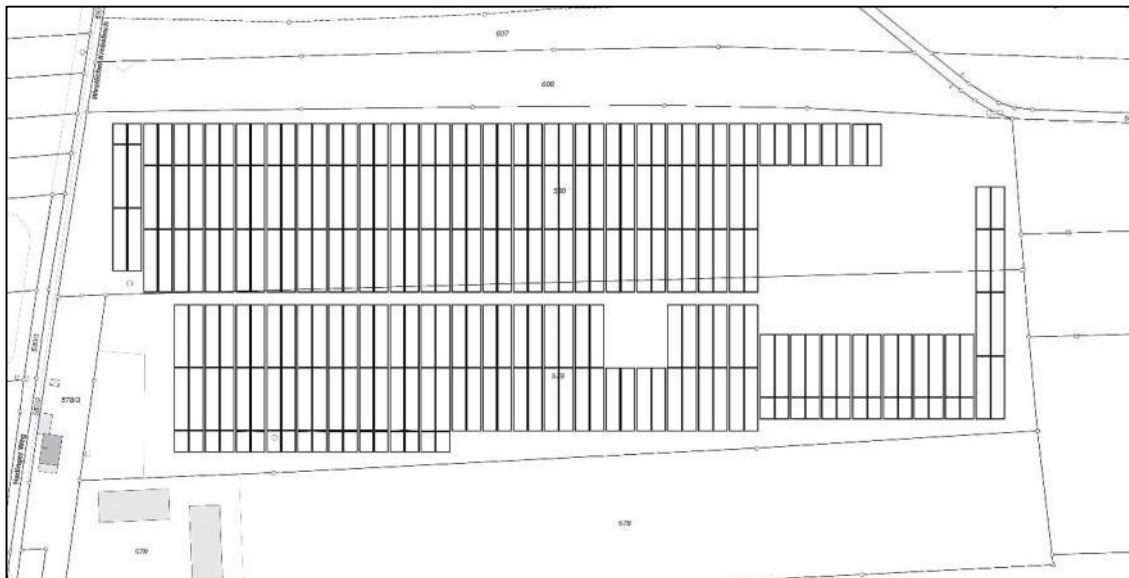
Lageplan der geplanten PV-Anlage /7/
